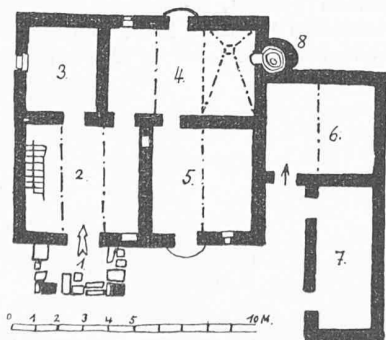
Grundriss des Bauernhauses auf Ibiza, 1: 300. 1 Gedeckter Eingang, 2 Porchu (Diele), 3 Kammer, 4 Küche, 5 Kammer, 6 Ställe, 7 Schopf und Kleinviehstall, 8 Backofen
